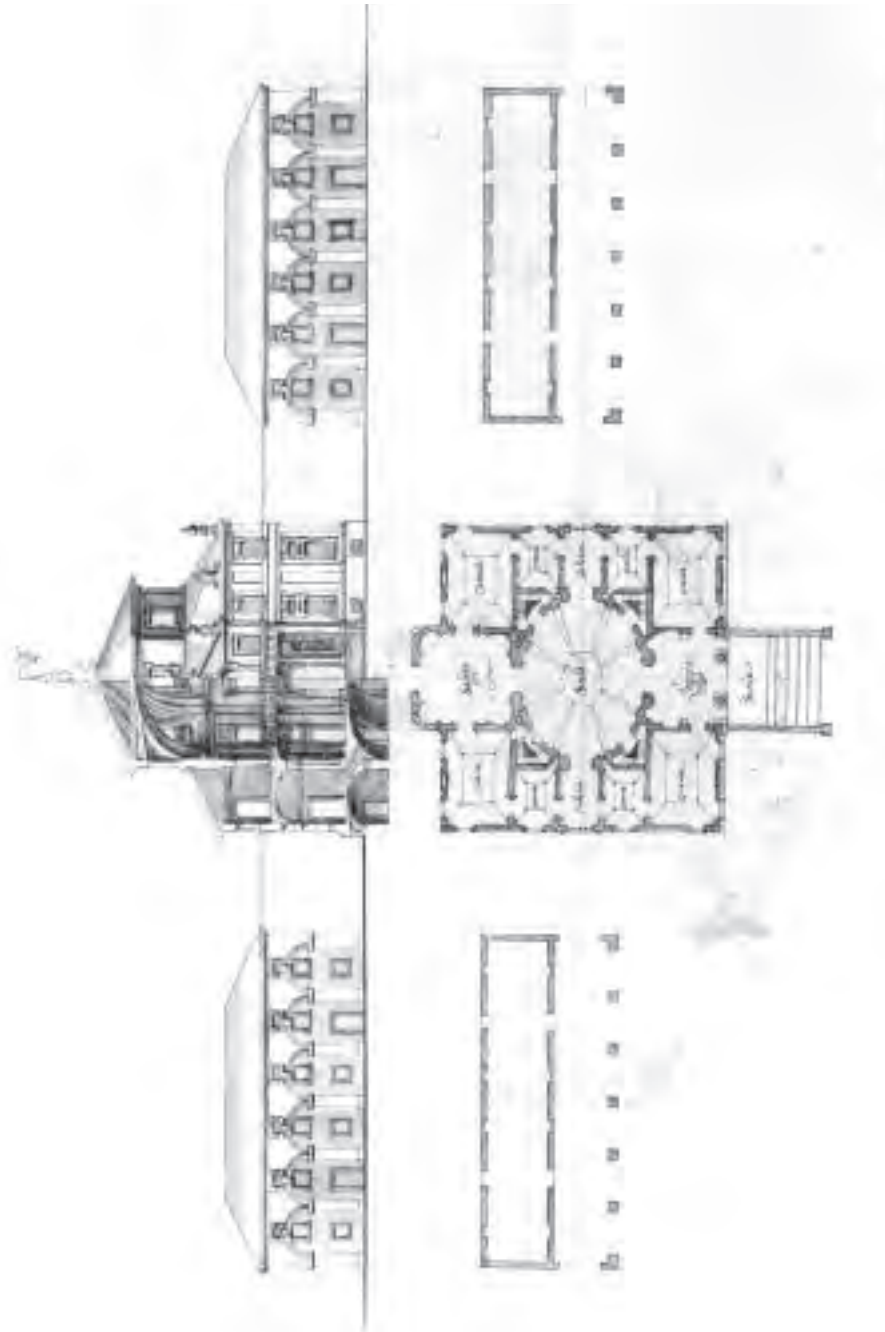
FIG. II. ANTONIO GASPARI, Prospetto e pianta di villa con salone ovato e barchesse, BMCVE: *Raccolta Gaspari*, III, 72.
